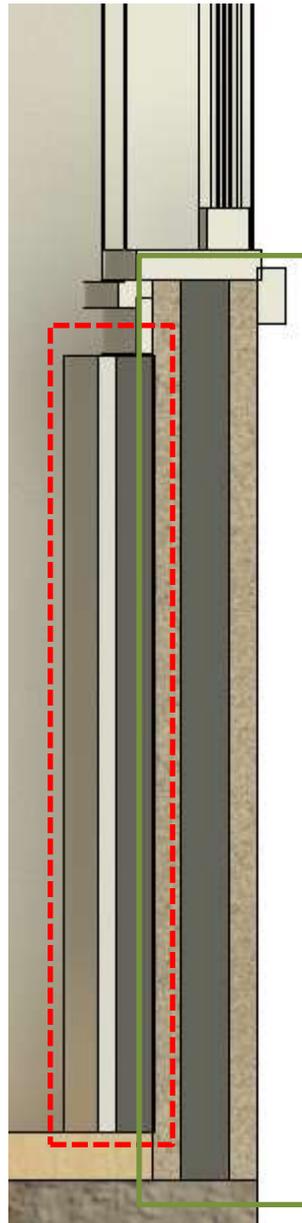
Pormenor aproximado - solução parede existente com isolamento proposto (em vermelho: proposto; em verde: existente)
